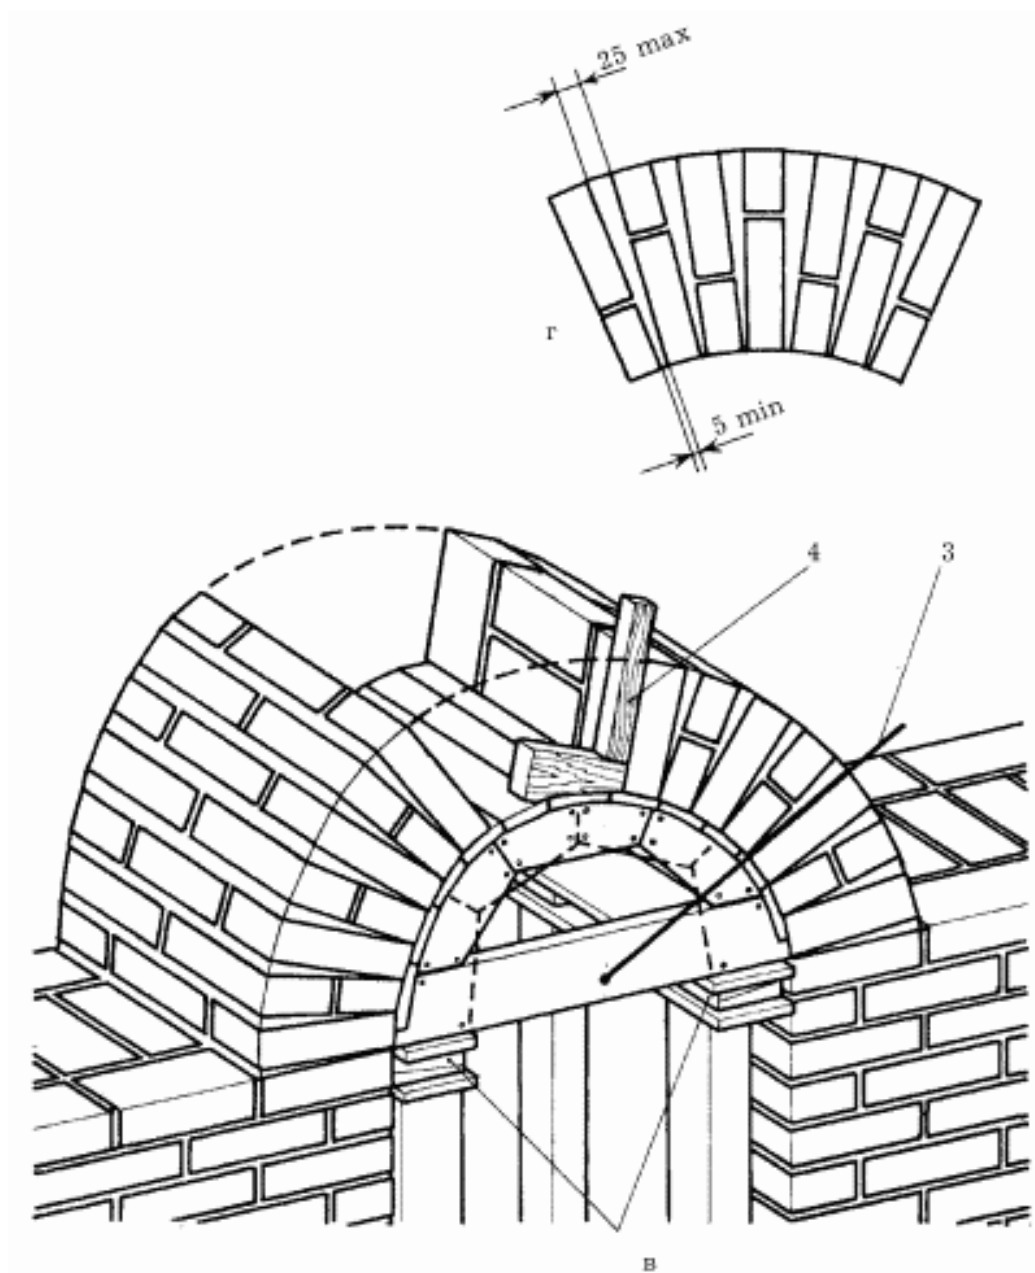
Кладка перемычек (продолжение): в – арочной; г – швы кладки: 3 – шнур; 4 – шаблон-угольник.
